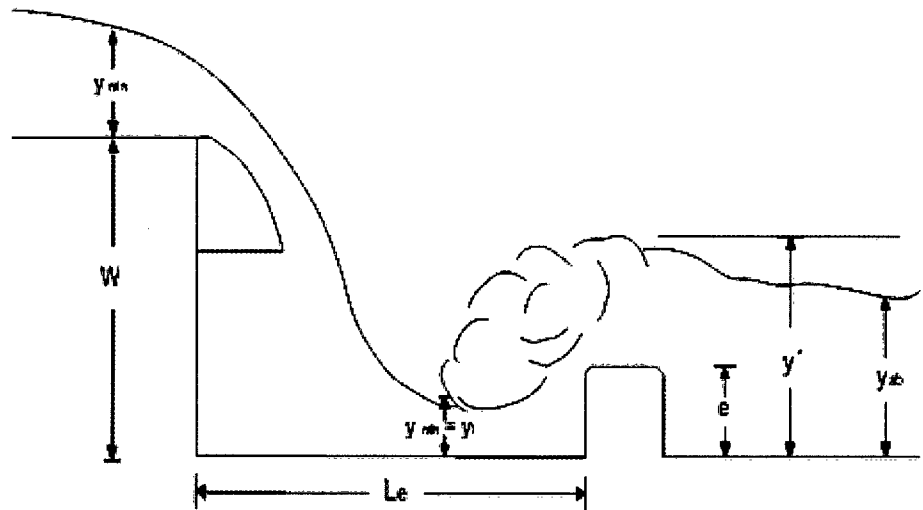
Estanque amortiguador con travesaño de fondo.
